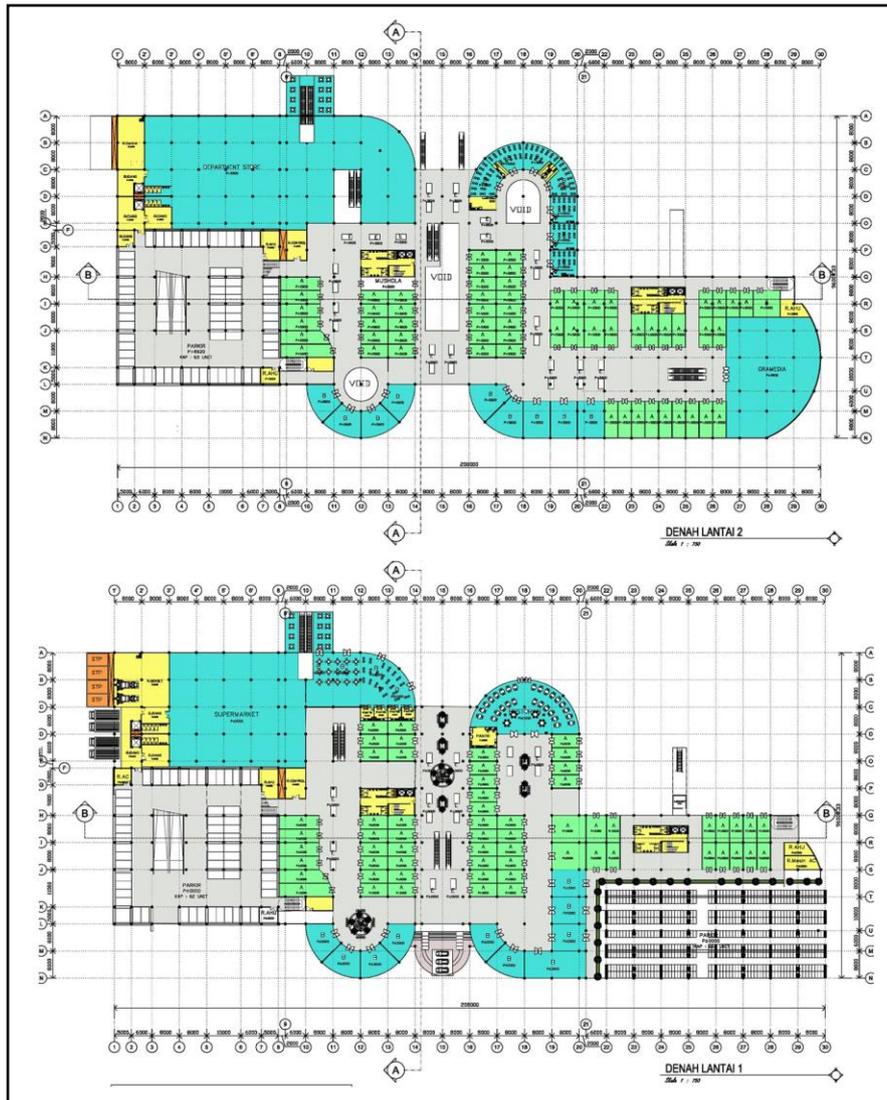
Siteplan *River Side Mall* di Kota Pontianak
